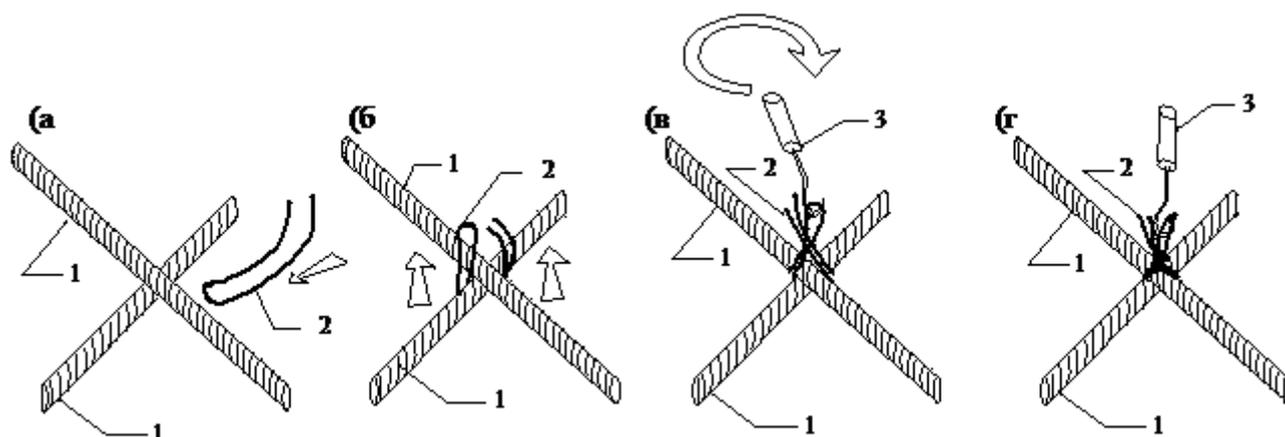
Схема фиксации арматурных стержней вязальной проволокой:
